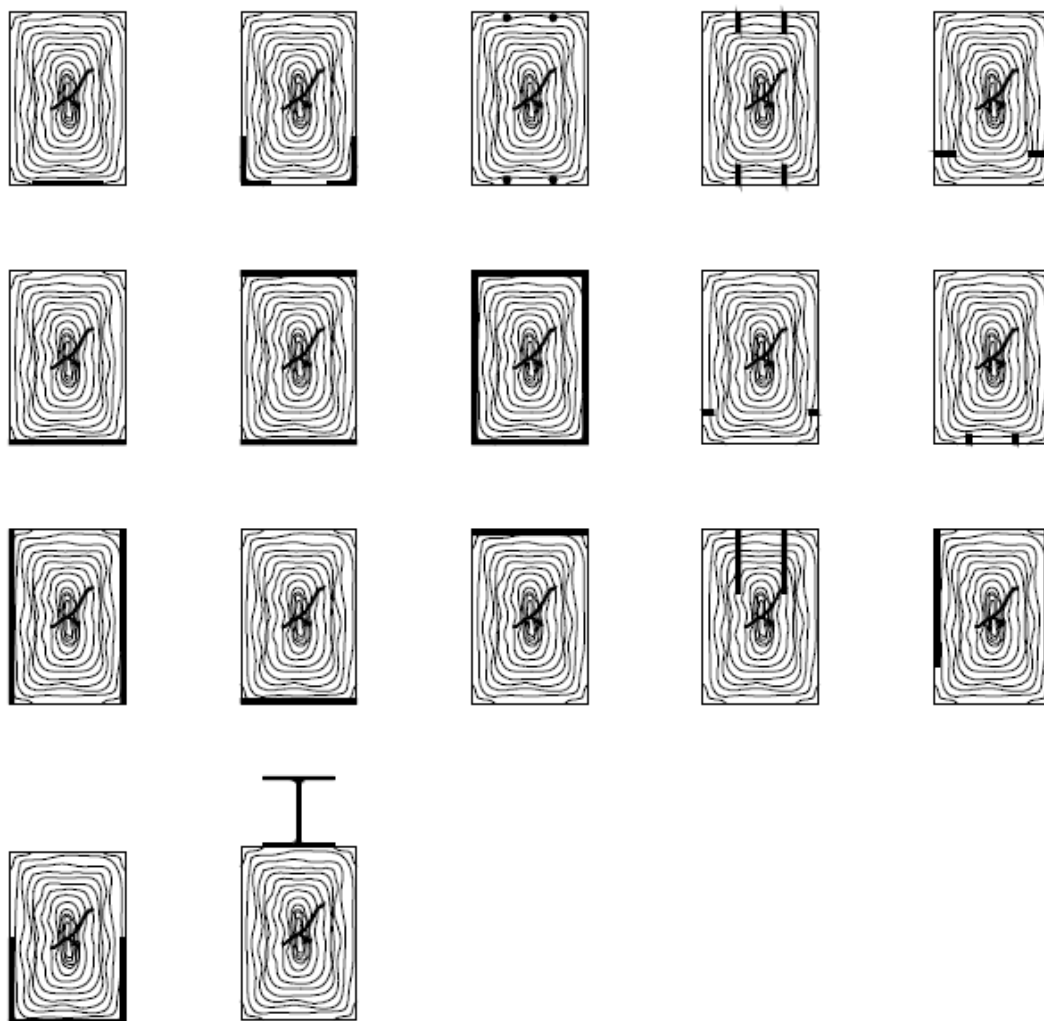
Conformações de reforço à flexão que podem ser aplicados em vigas de madeira.
